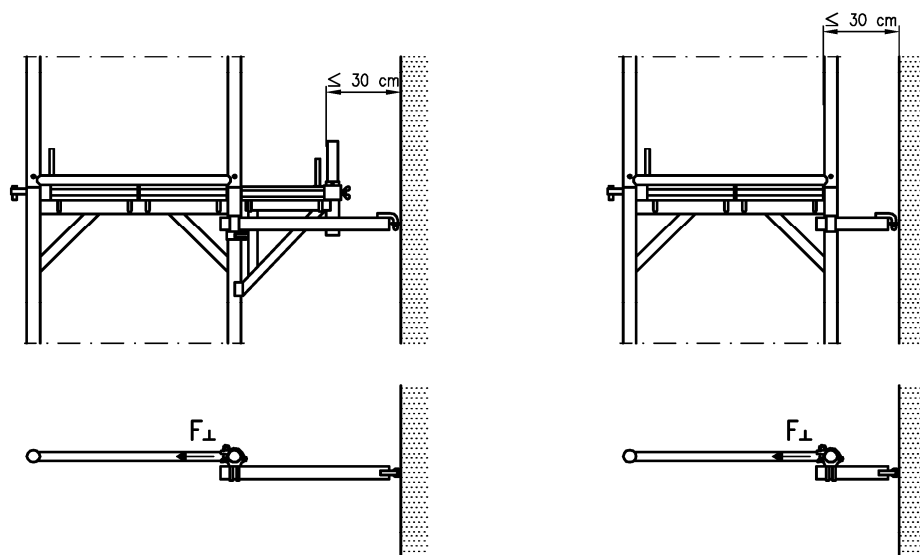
Höhenlage der Gerüsthalter bei Anschluss im "Knoten"
